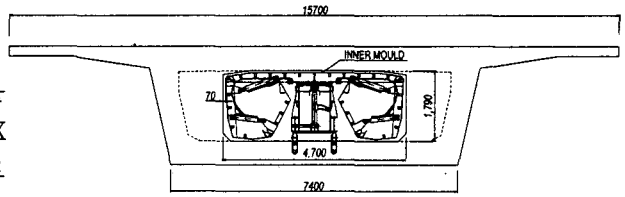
격벽부 횡단면도 및 Inner Mould 형상
